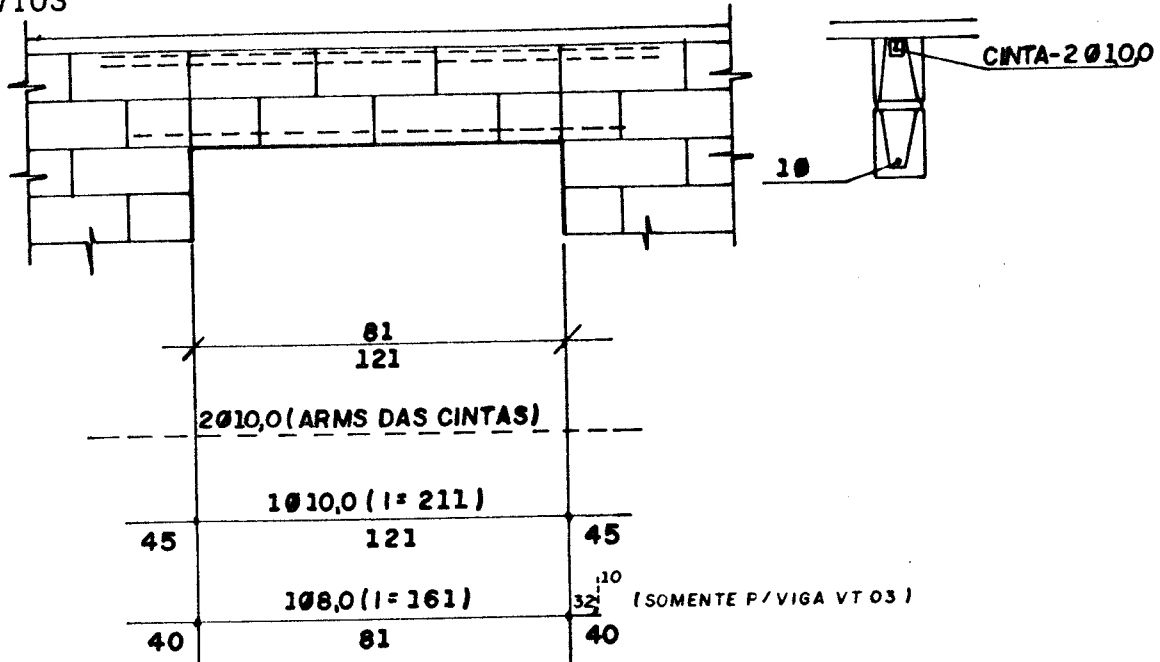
ARMAÇÃO DAS VIGAS DO ÚLTIMO PAVIMENTO
